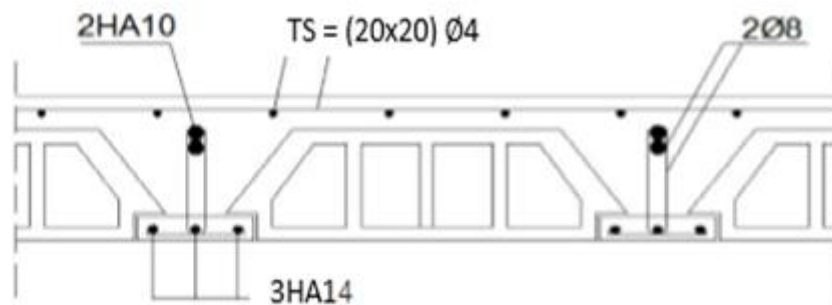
Schéma de ferrailage du plancher RDC
